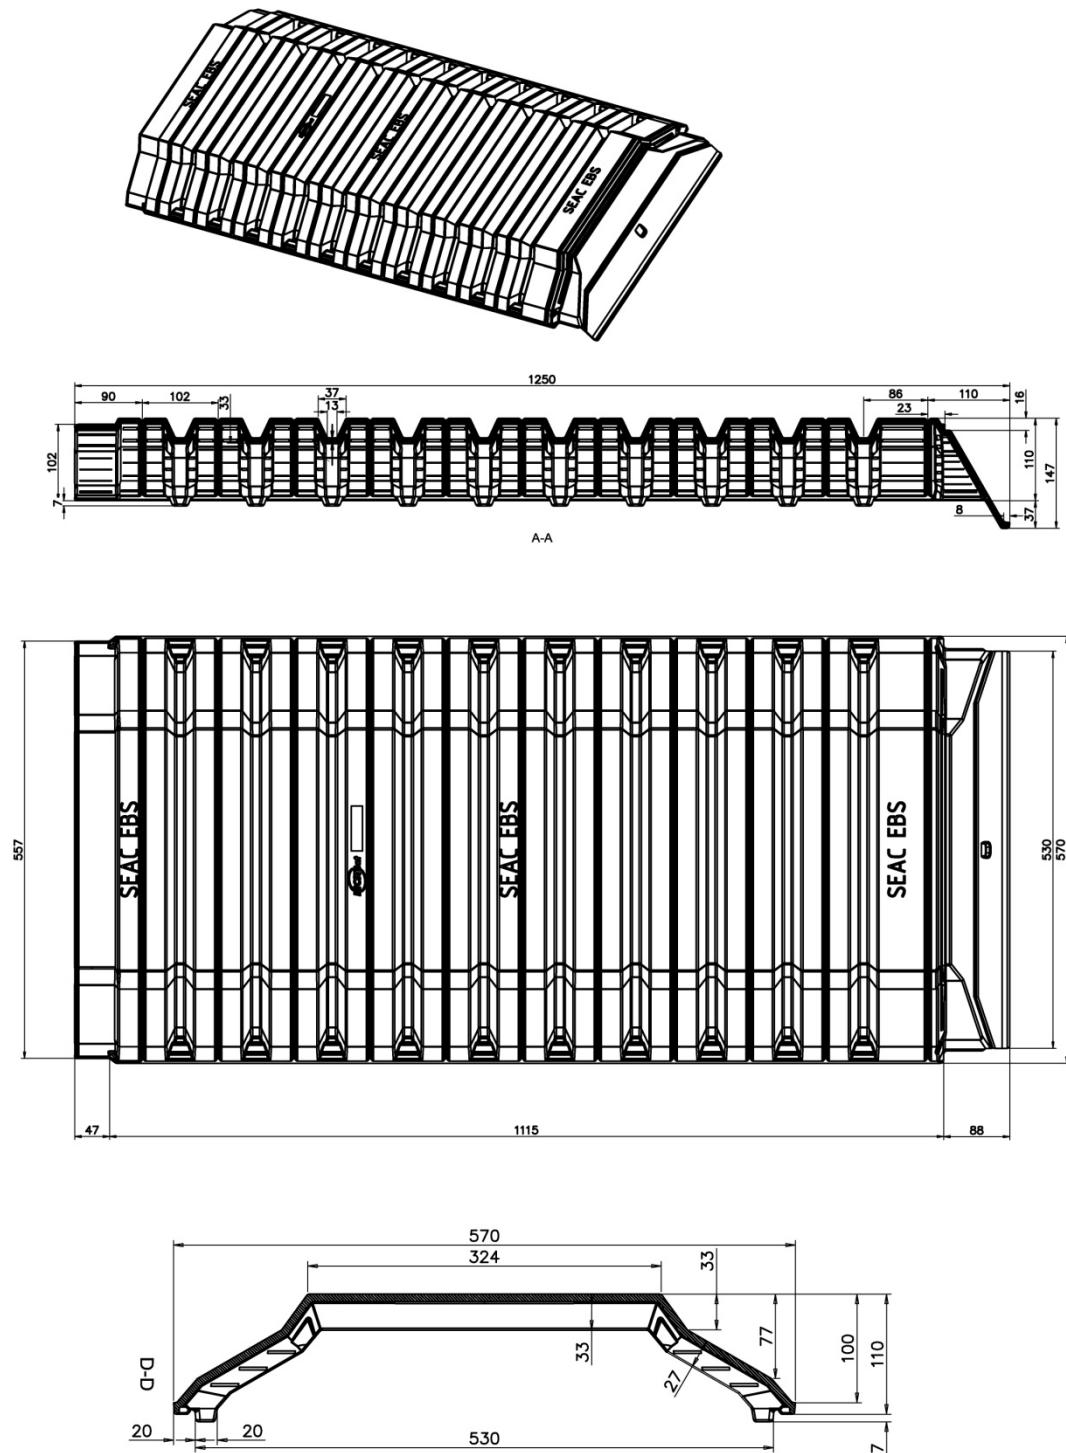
Définition entrevois EBS de 15 - Hauteur coffrante de 14,5 cm vues globale, longitudinale, de dessus et section transversale
